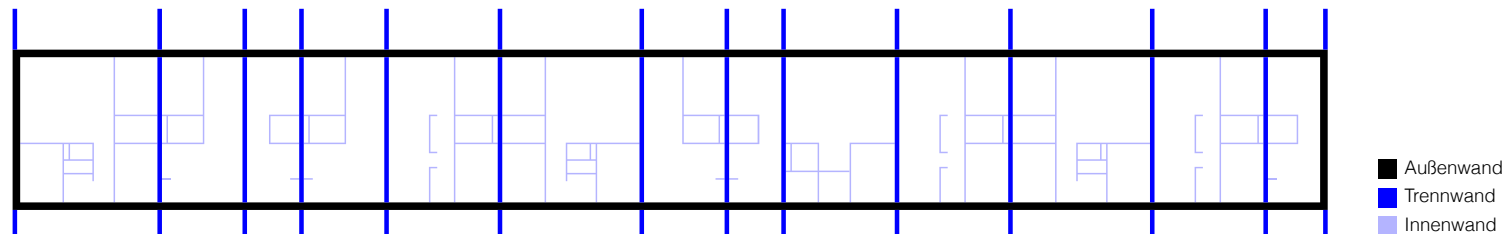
Tragwerksplan Ausschnitt II | M 1.200
